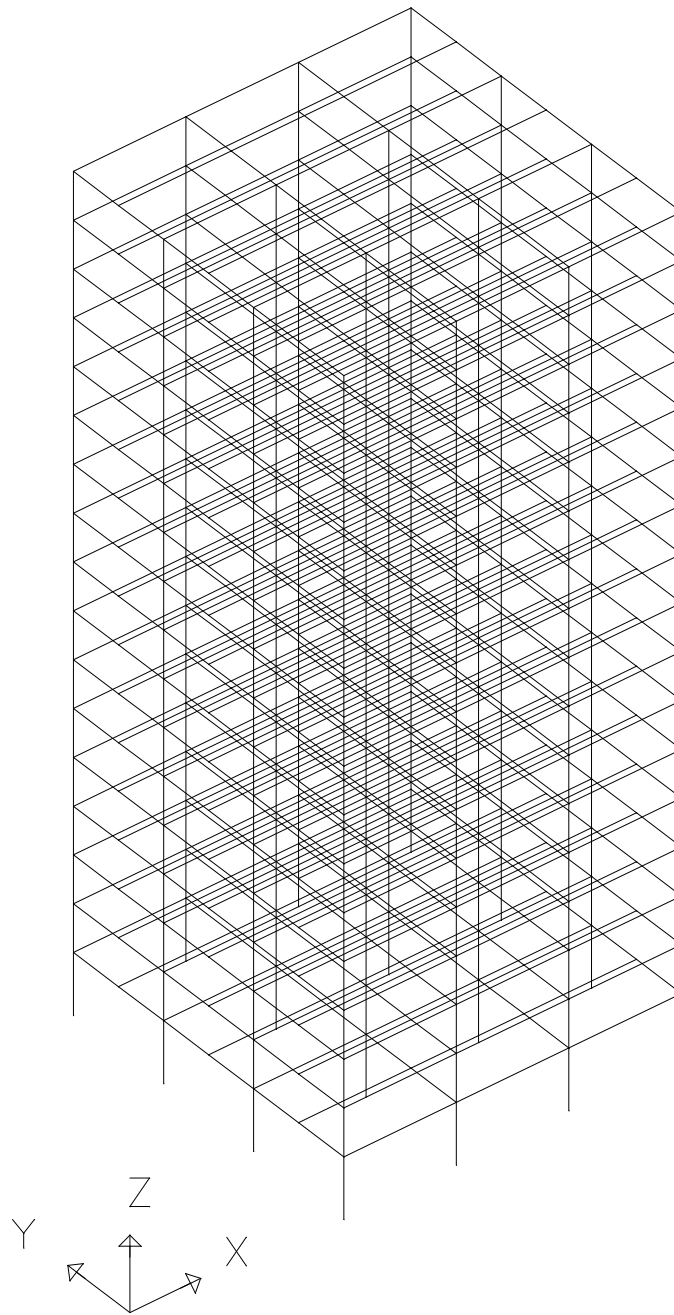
Modelo matemático tridimensional de las estructuras de 17 niveles
